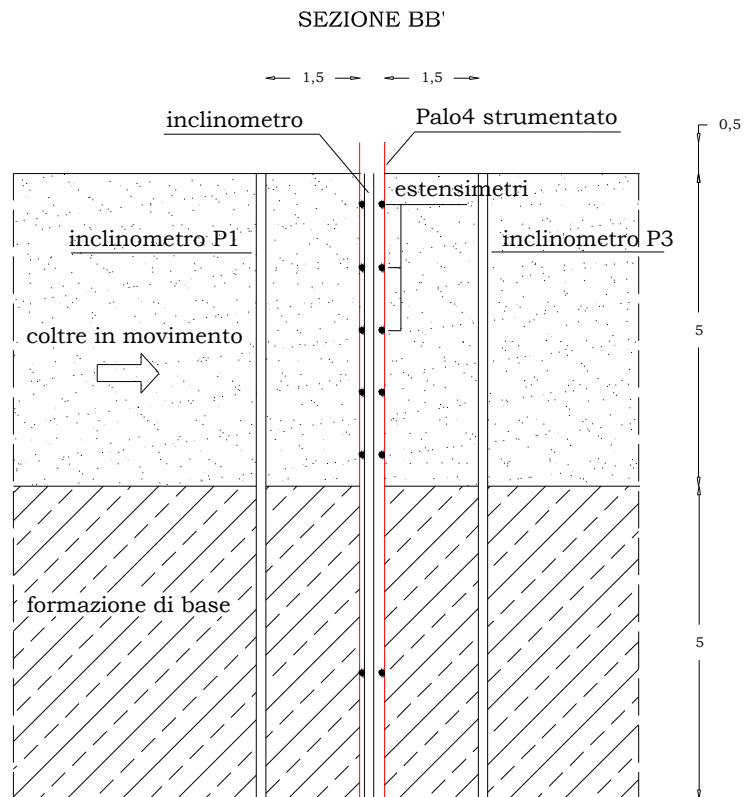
Sezione dell'intervento e posizione barrette estensimetriche
